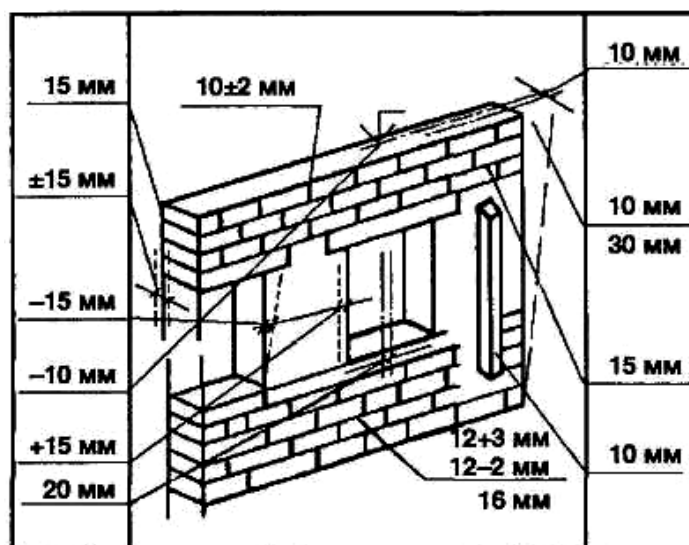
Допускаемые отклонения при кладке наружных стен
